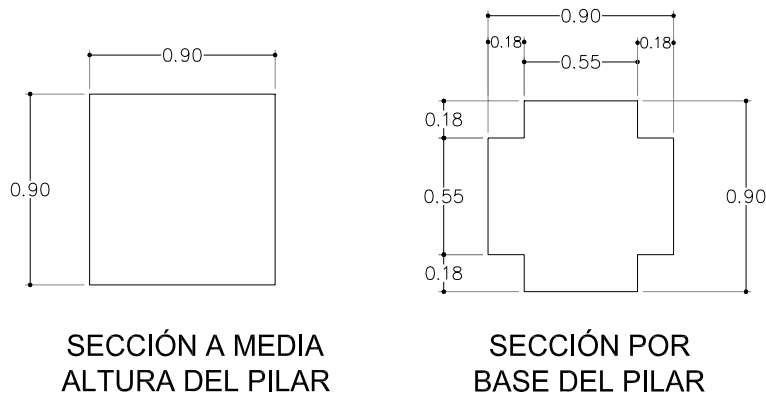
Pilares de hormigón. Reducción de la sección inferior. Fig. 3.- Foto de pilar de hormigón.
